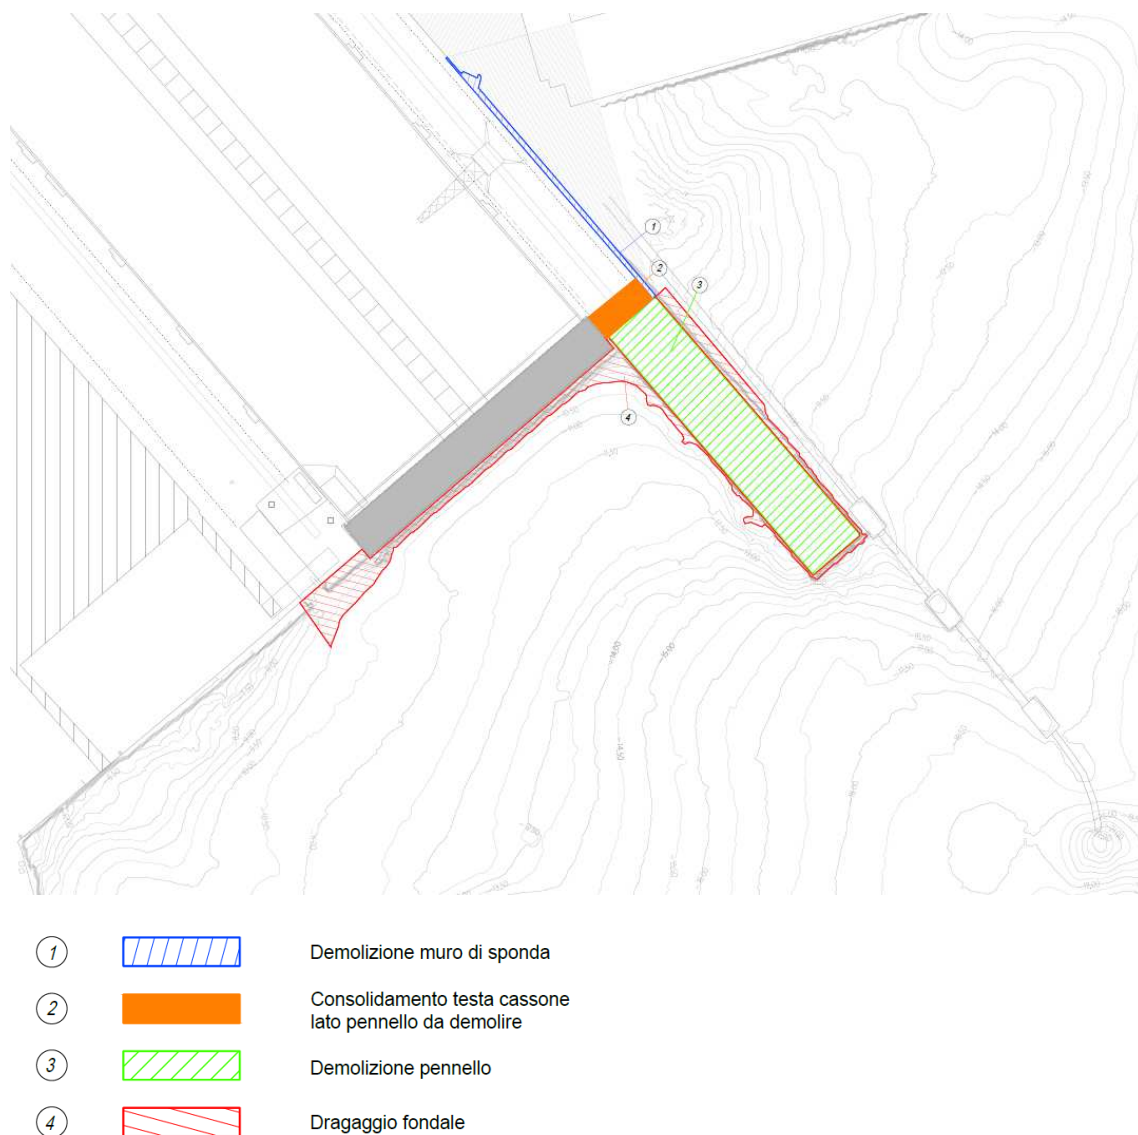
Planimetria con indicazione degli interventi previsti nel Lotto A
